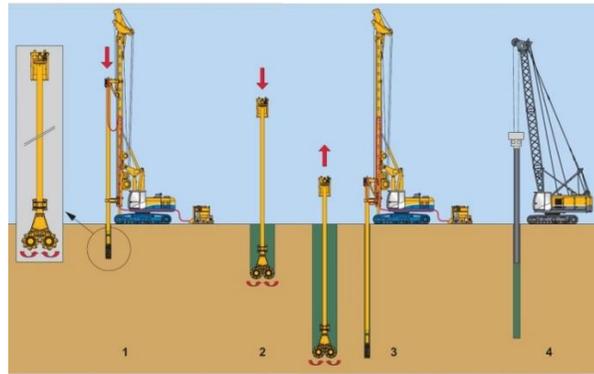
Cimentación por medio de pilotes [ilustración].
